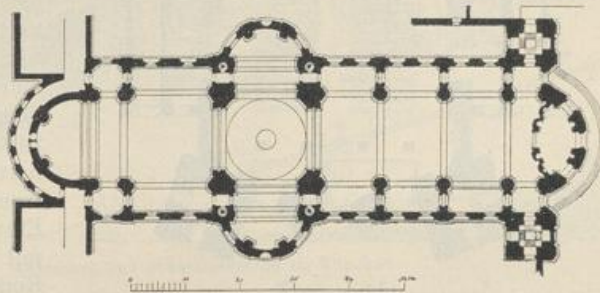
Grundriss der Klosterkirche zu Weingarten
